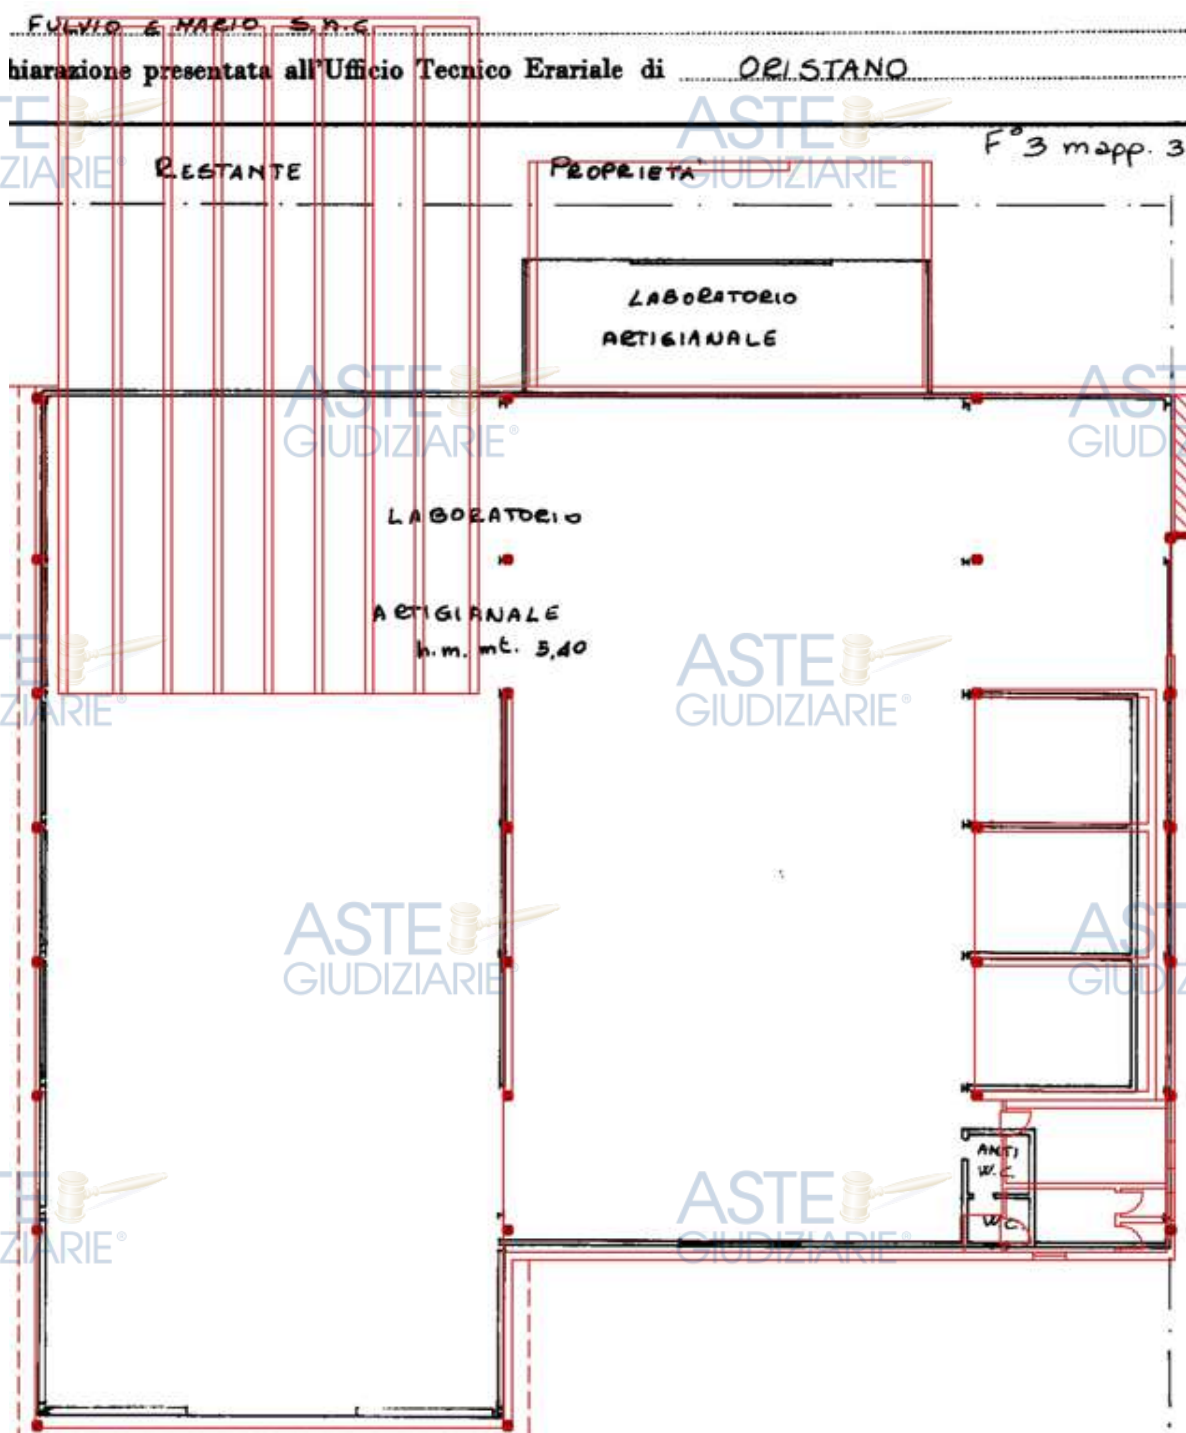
Stralcio planimetria catastale imm. 4 (capannone). Sovrapposizione con rilievo. Fuori scala, nord a destra.
